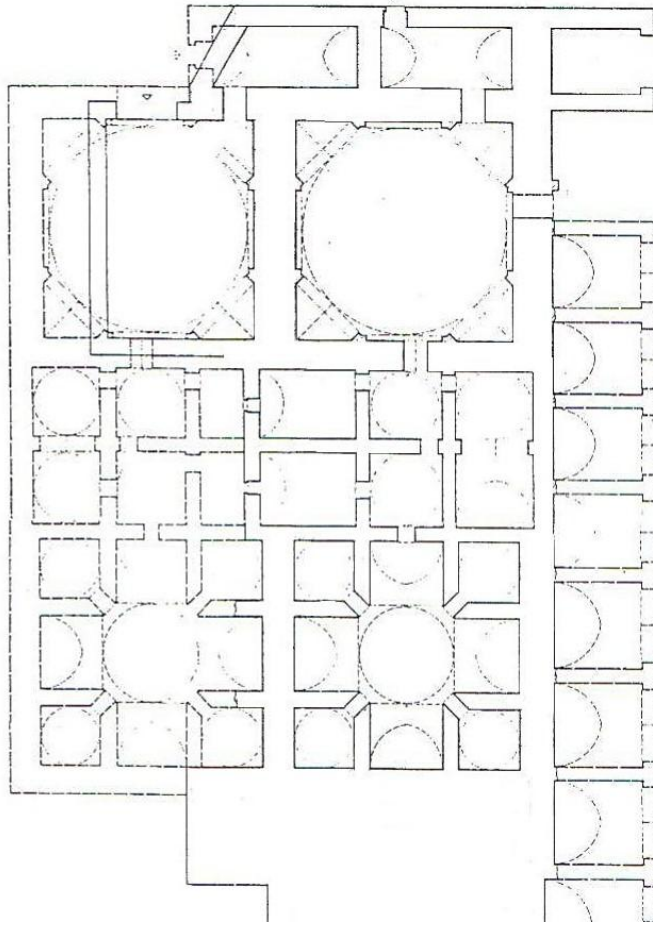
Gazi Mehmet Paşa Hamamı plan şeması
